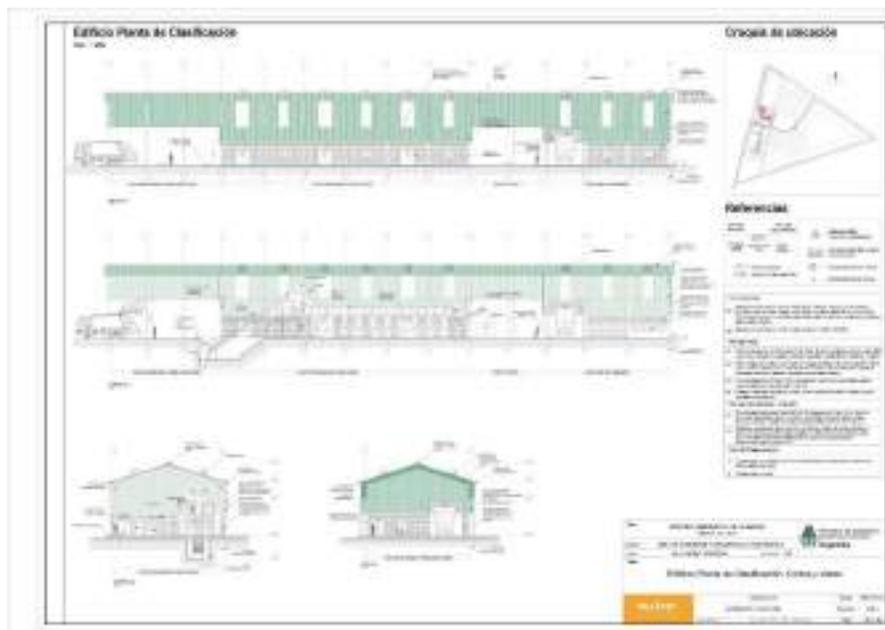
Villa María - Planta de Separación y Clasificación – Vista lateral.
